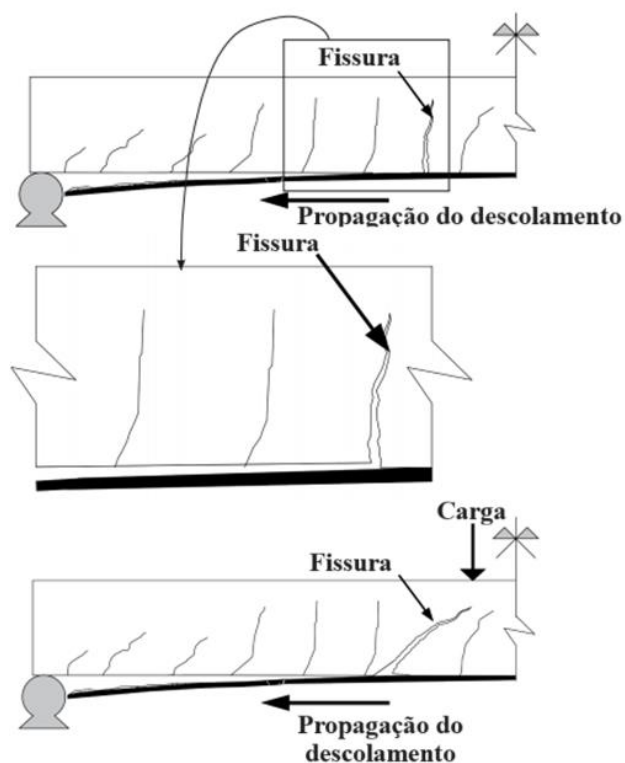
Desprendimento no concreto de cobrimento das armaduras. Induzido pela fissura crítica na diagonal, próxima ao apoio, adaptado do *Bulletin fib 90* (2019).
